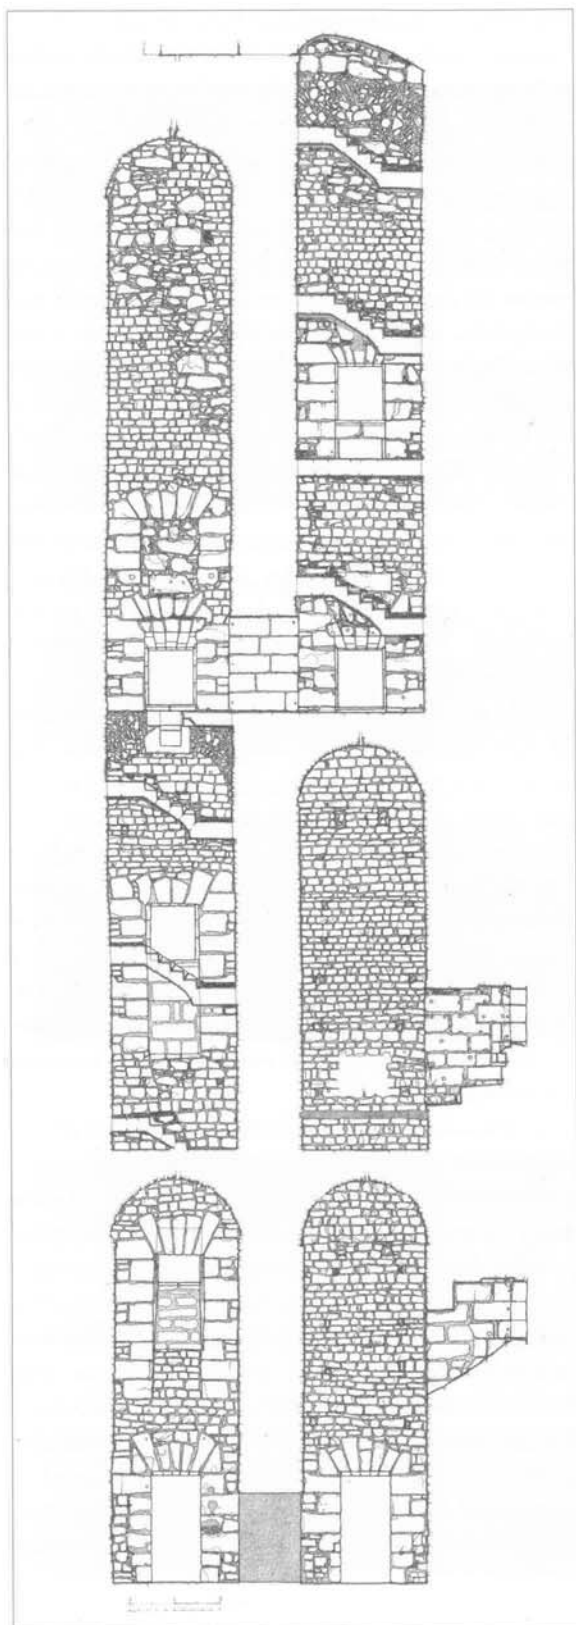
Alzado de la cara interior del muro de la fachada principal. M. Á. Núñez.
